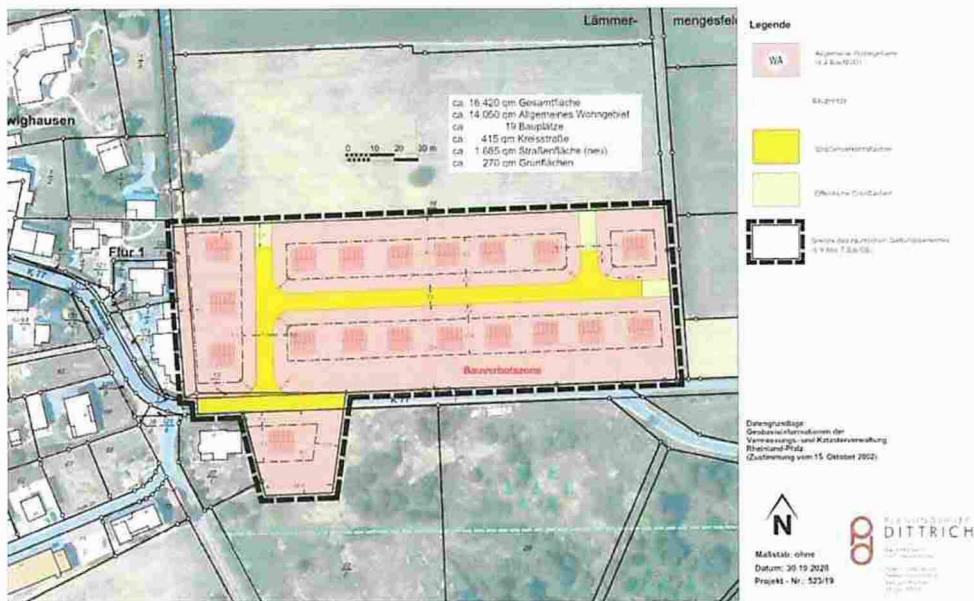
Planfassung Vorentwurf von 30.10.2020
